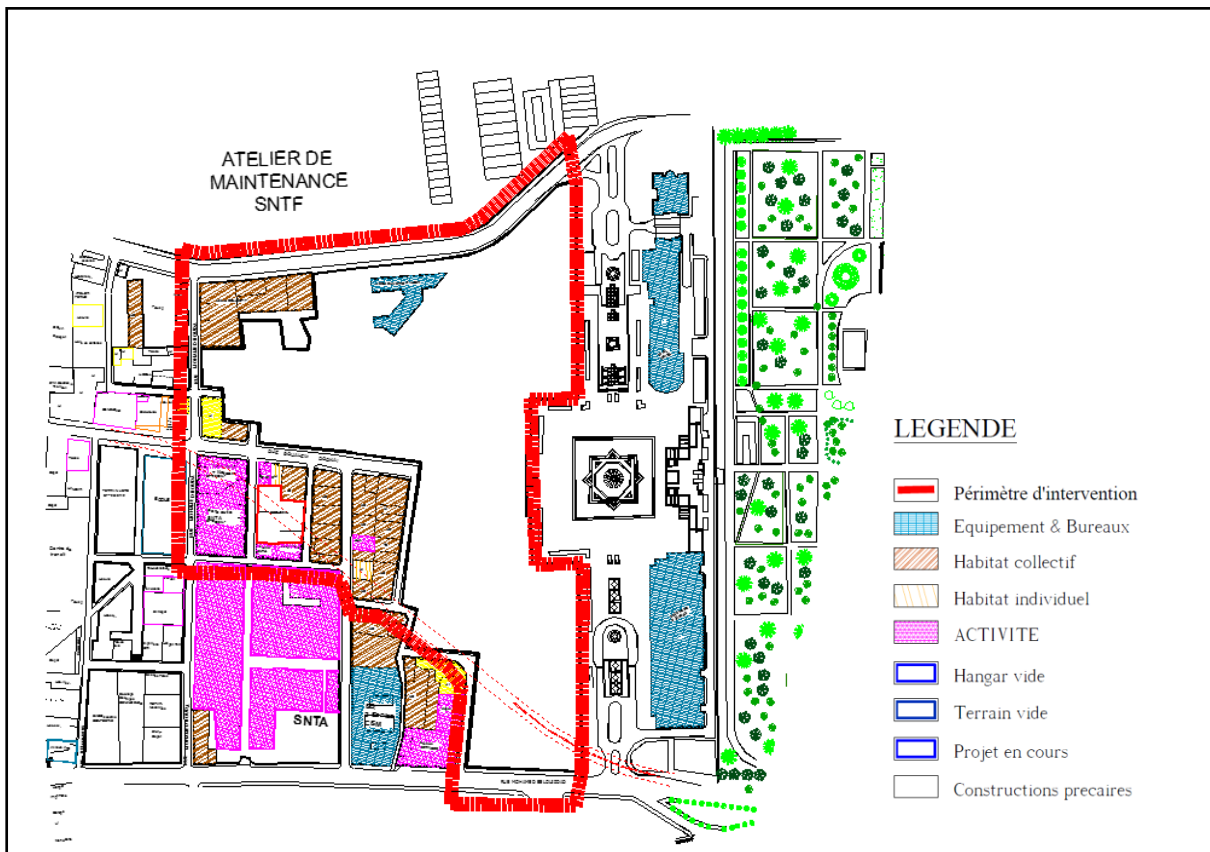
Plan état de fait de l'ilot des 18 ha
